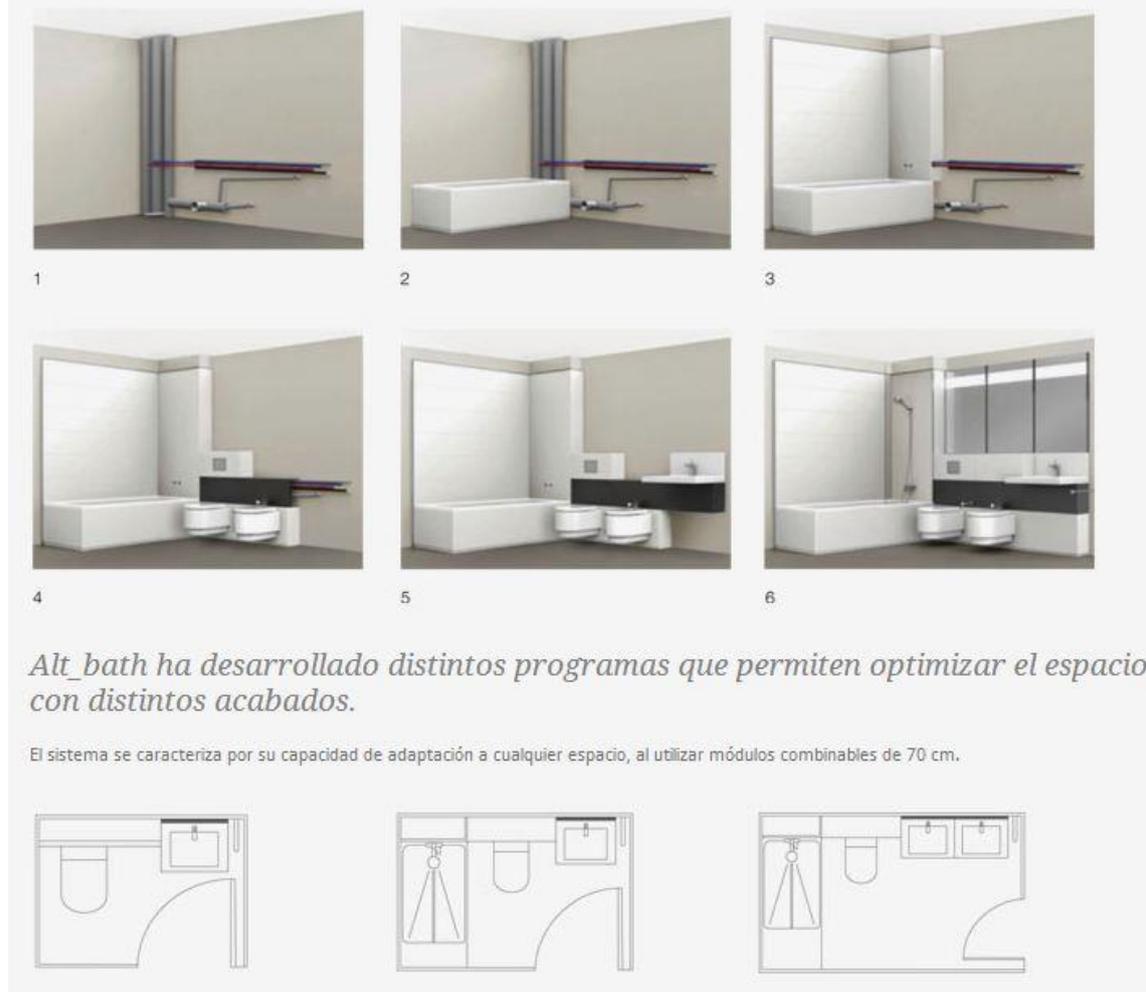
Sistema de montaje en 24 h. (fuente : Alt Bath).
